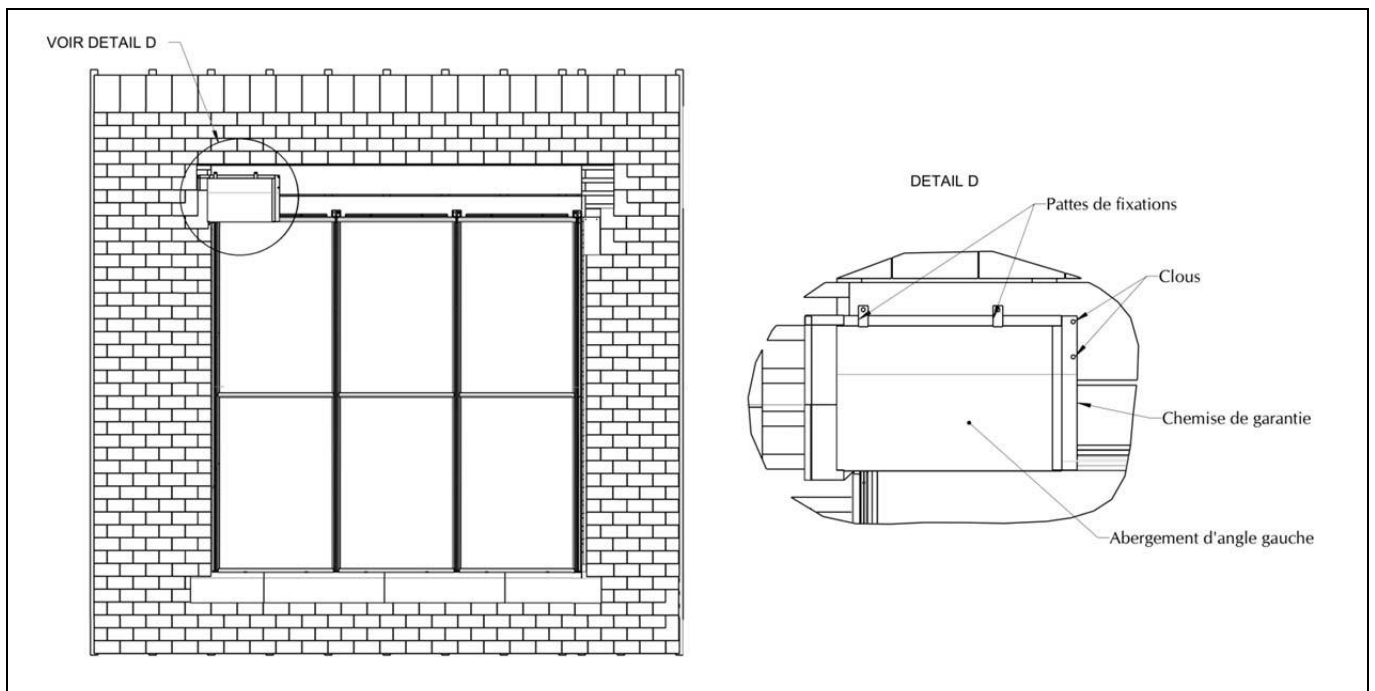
Pose de l'abergement supérieur gauche pour installation sur toiture ardoise
